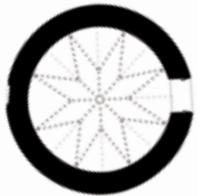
Grundriss Kielhauser/Krappinger/Lechner 2008. M 1:400.
